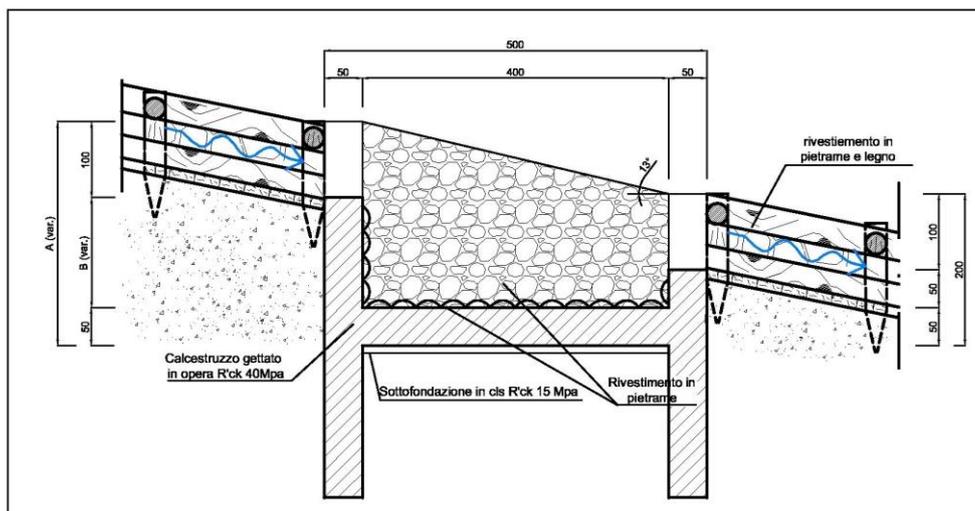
Compluvio nord – Vasche tipo Vn1-Vn8 - sezione
